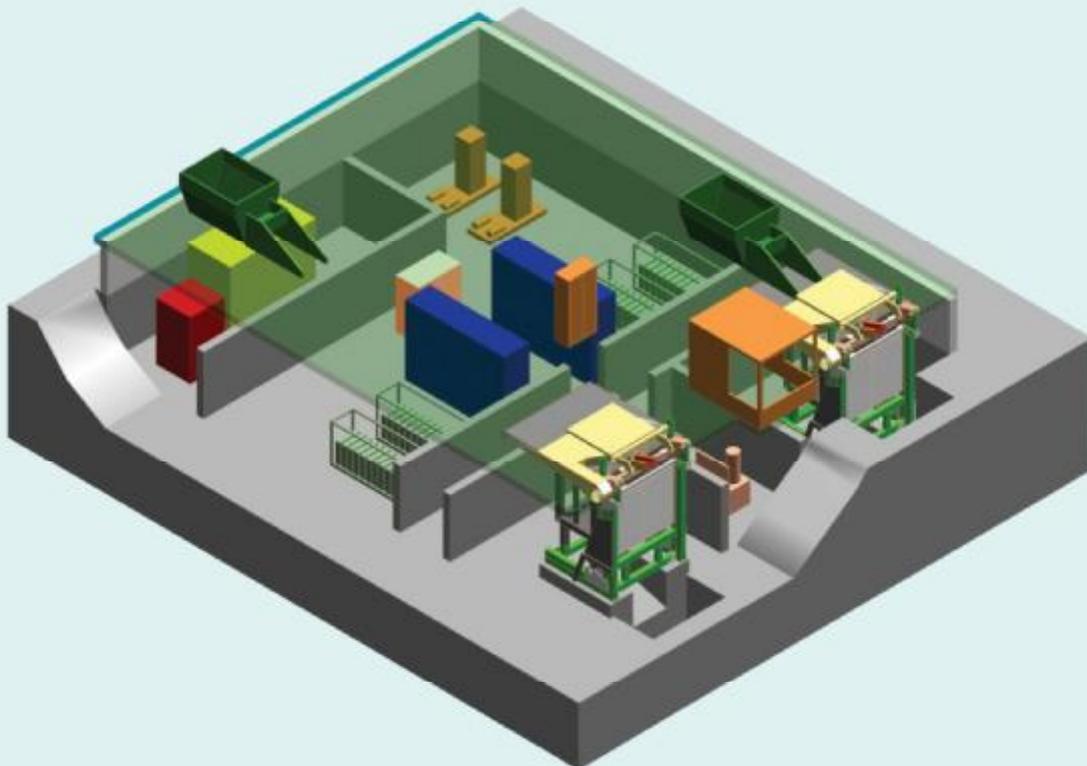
Типовая планировка размещения оборудования плавильных установок УИПД
